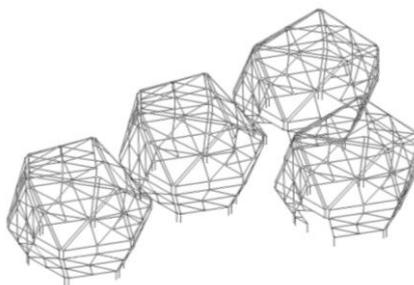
Sub estructura tubular metálica de soporte para piel exterior.
